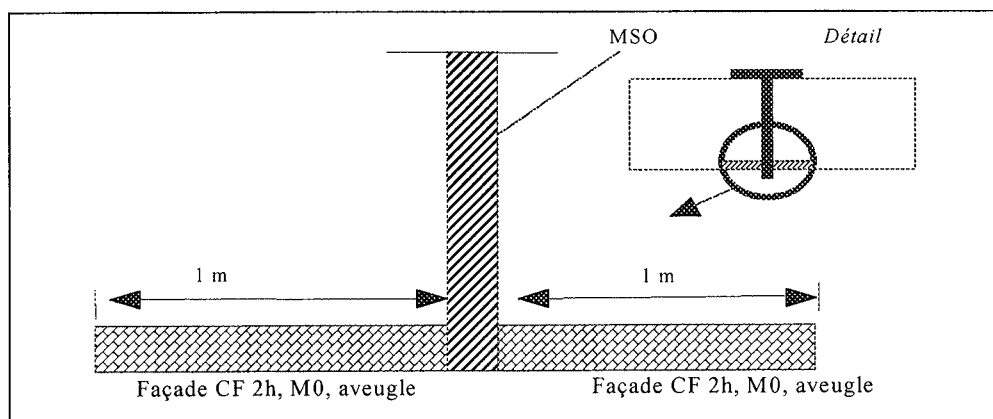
b. :Autres conditions de non-dépassement sur les côtés d'un MSO.
